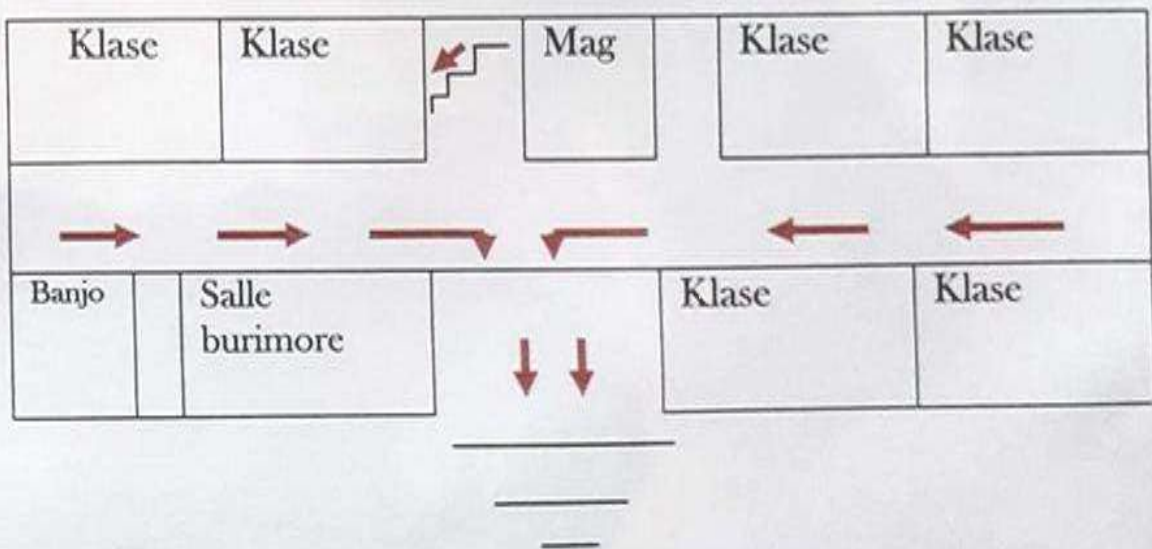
Planimetritë për katin përdhe, të parë dhe të dytë
